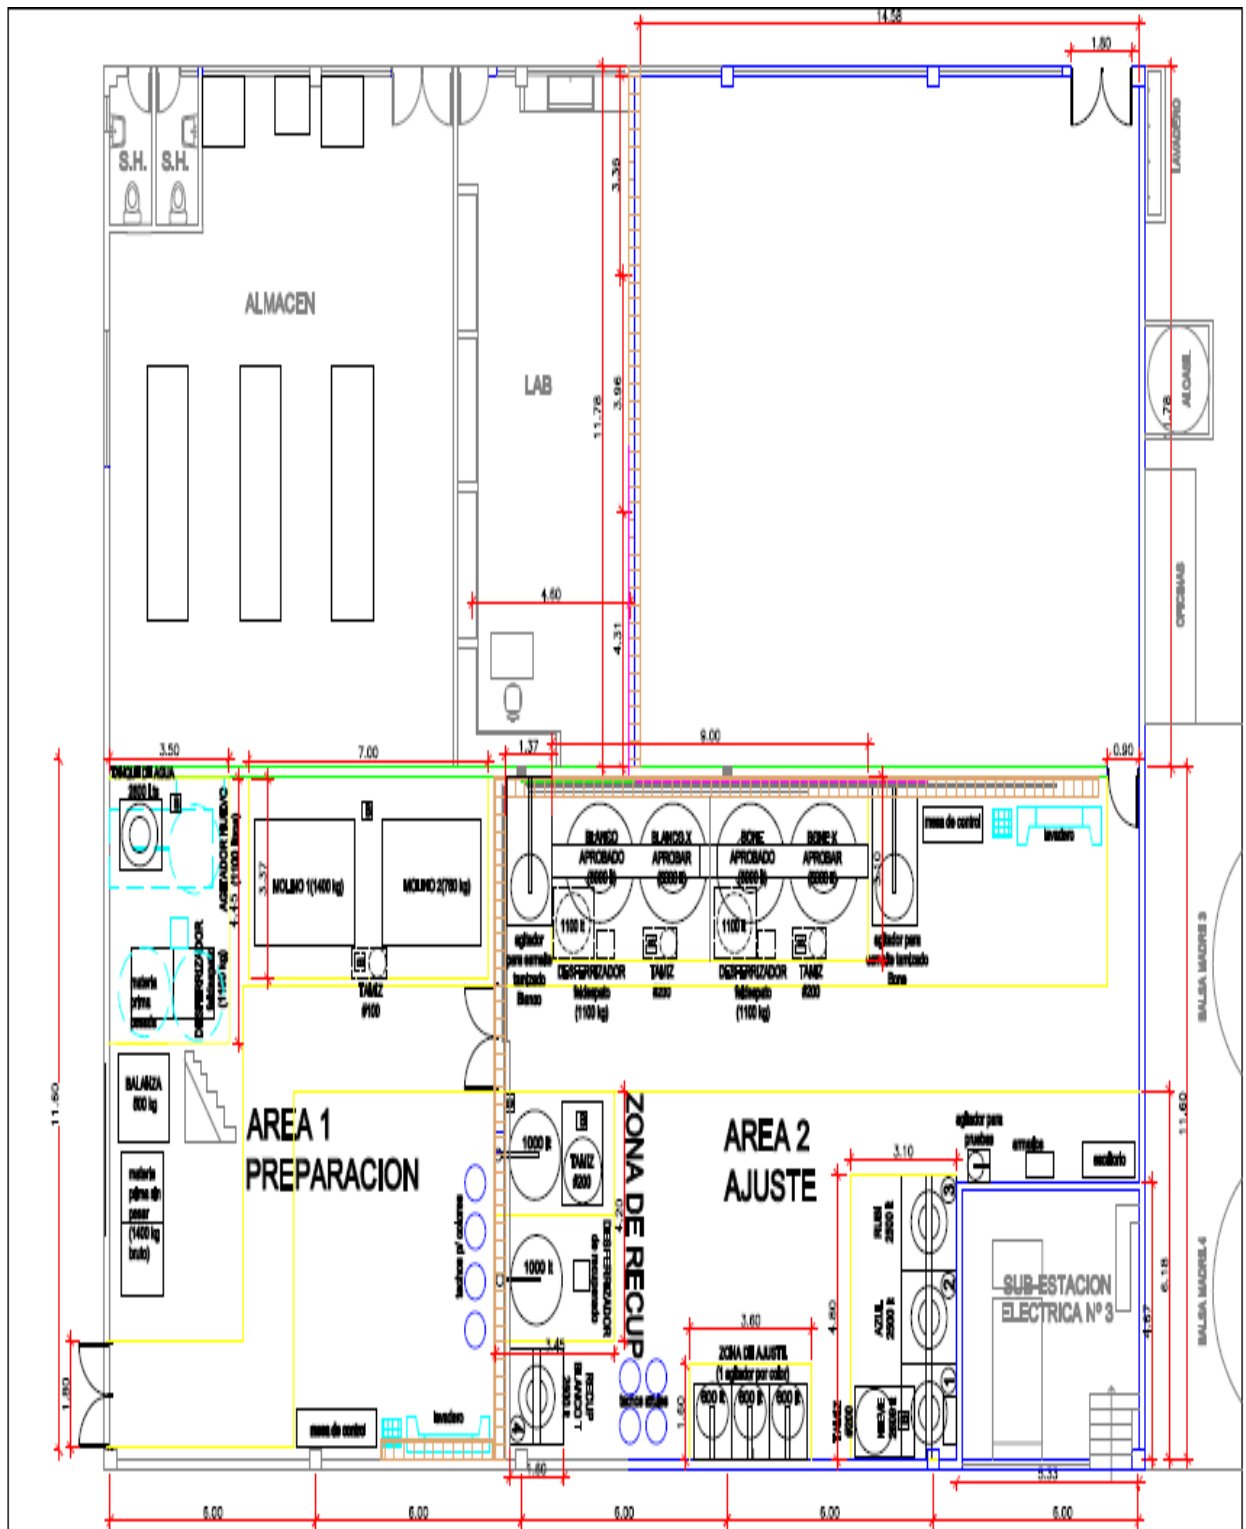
Layout mejorado de planta de sanitarios cerámicos
